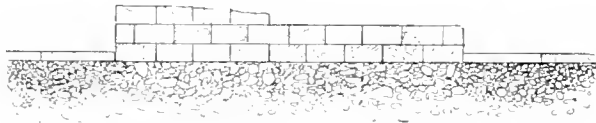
COUPE TRANSVERSALE D'UN MUR.
